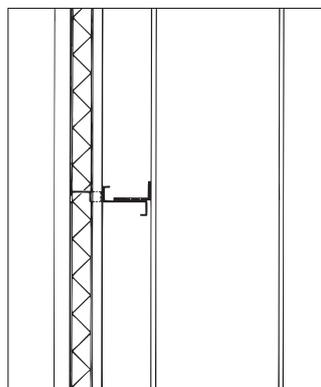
b: Wandanschluss, profiliertes PUR-Sandwichelement
